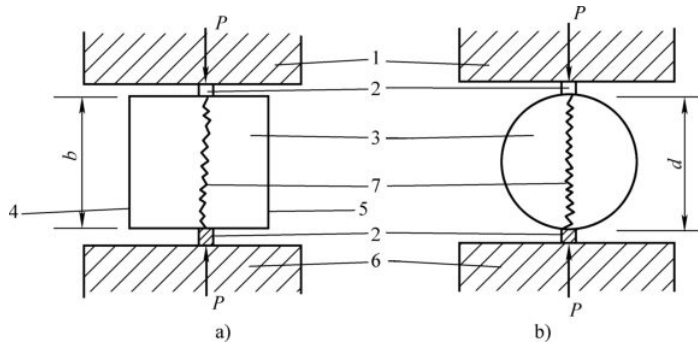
用劈裂法试验混凝土抗拉强度示意图
